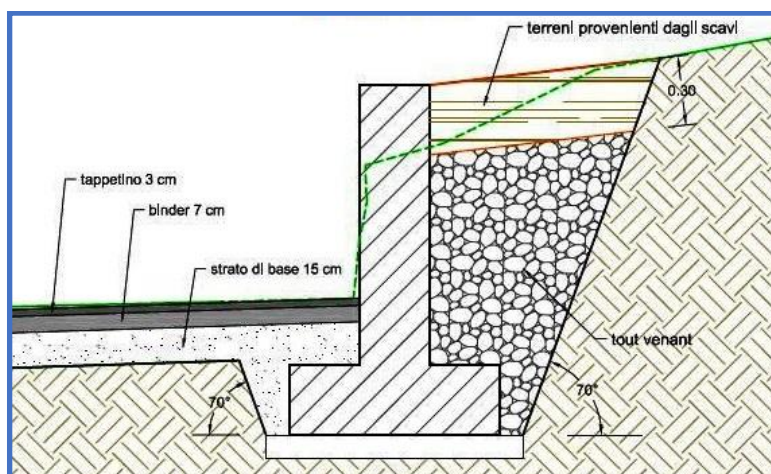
Zona intervento 3 – Sezione tipo del muro in c.a.
